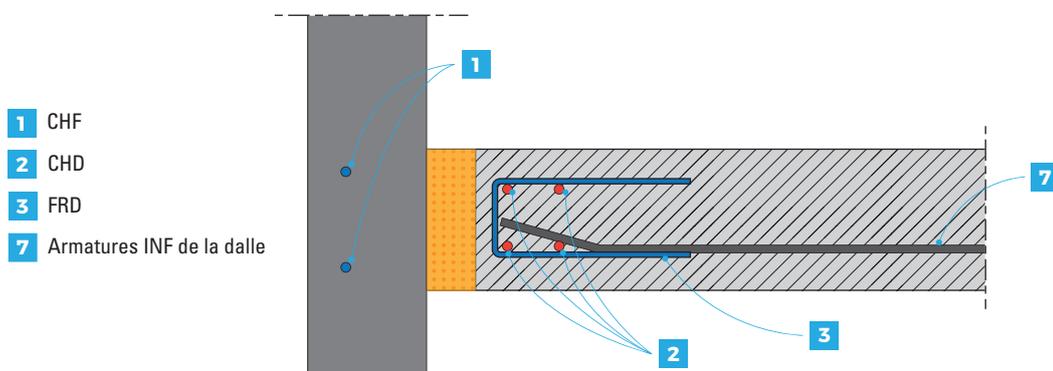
Exemple de dispositions constructives au droit d'un isolant
